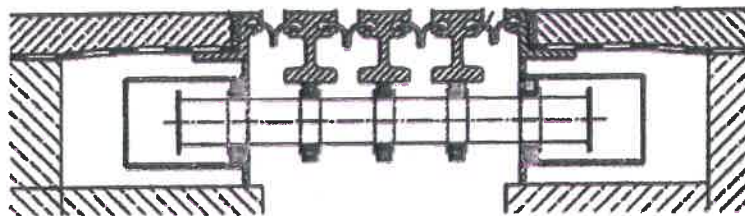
Sectiune transversala rost de dilatare modular cu traversa, pentru suprafata pietonala. Figura prezinta dispunerea traversei pentru ghidaj.
